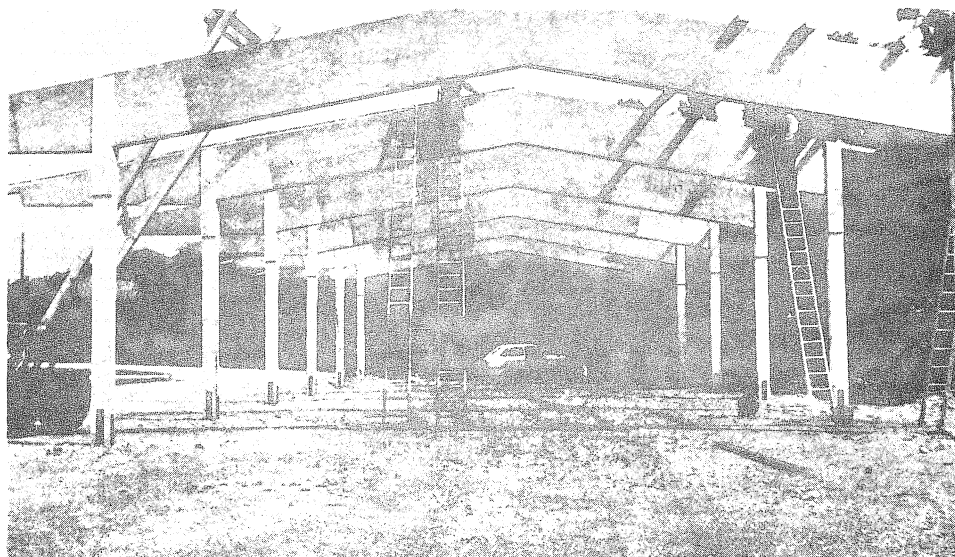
Rohbau einer Satteldach-Kastenträgerhalle mit 12,5 m Spannweite, 5 m Binderabstand und 4 m Vordach.
